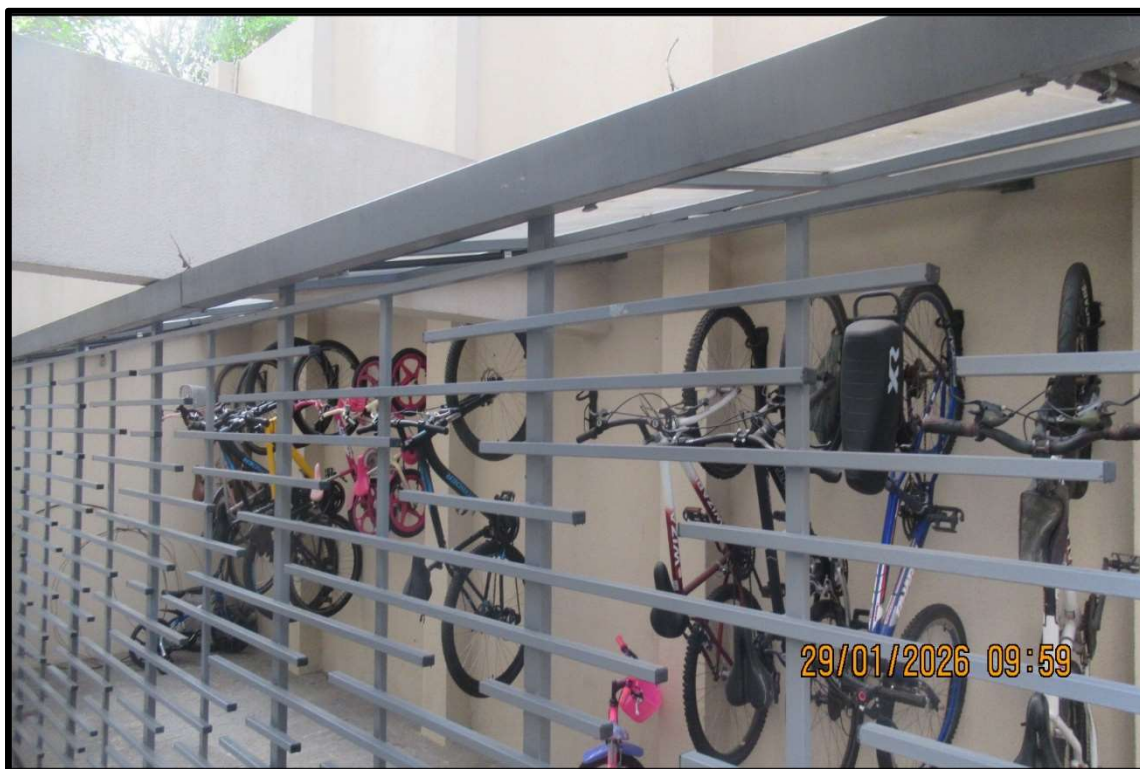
Vista do espaço destinado a abrigo de bicicletas.
